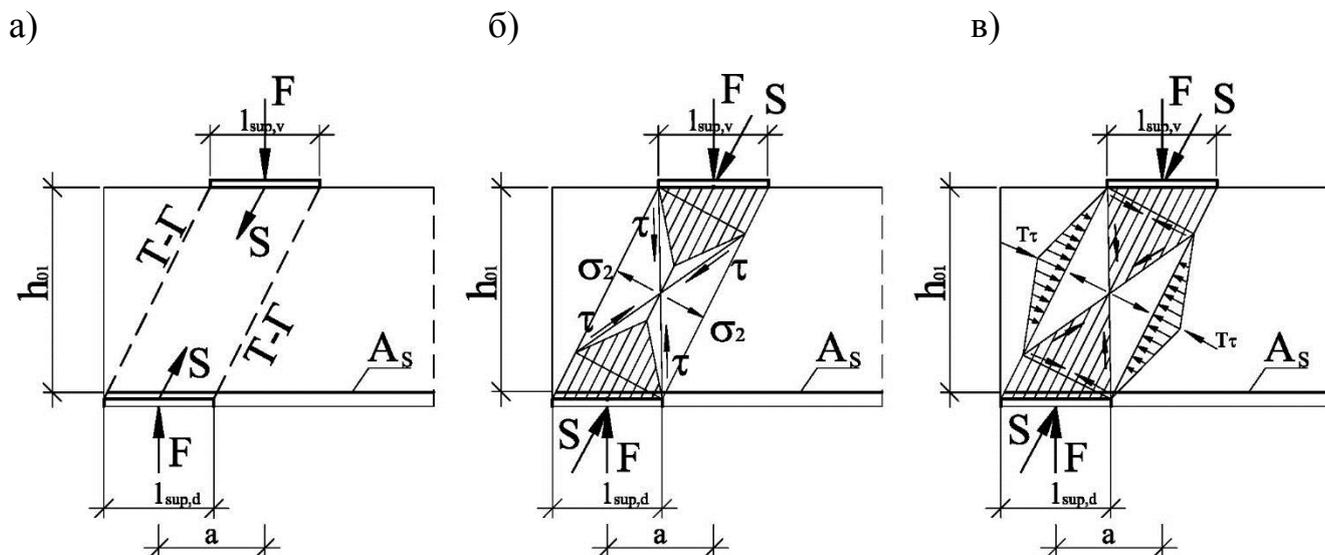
Схема поэтапного сопротивления разрушения бетона сжатой полосы: а – схема образования трещин; б – схема формирования диагональных сечений среза; в – схема сопротивления бетона, окружающего расчётную бетонную полосу
